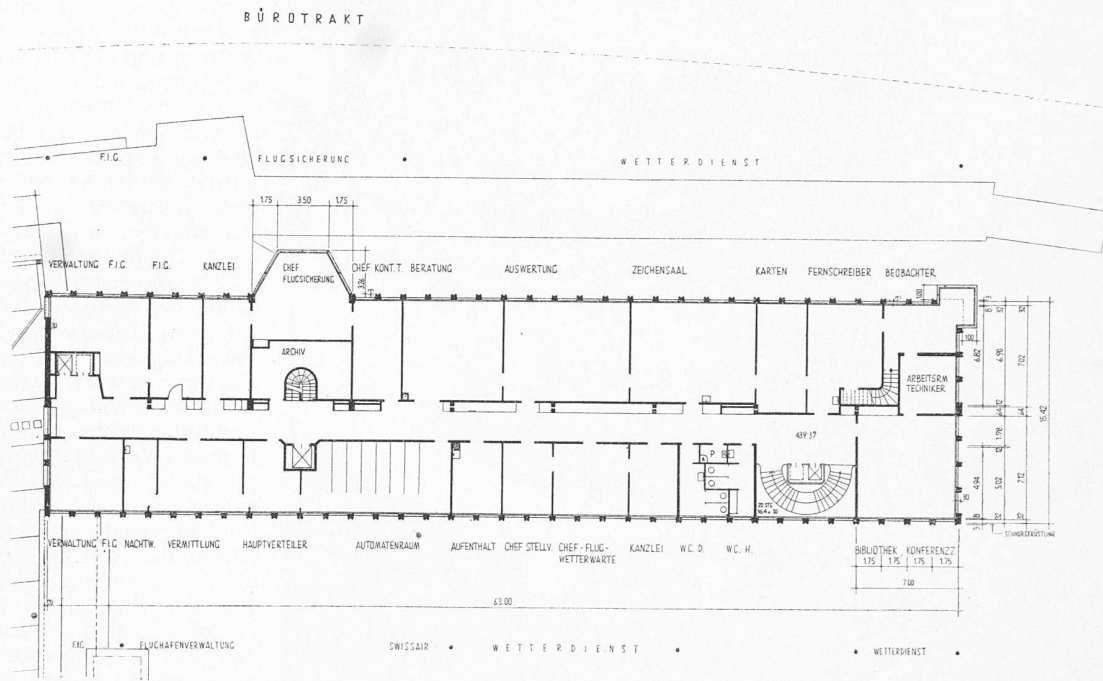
Bürotrakt, Grundriss des dritten Stockes, Masstab 1:500
